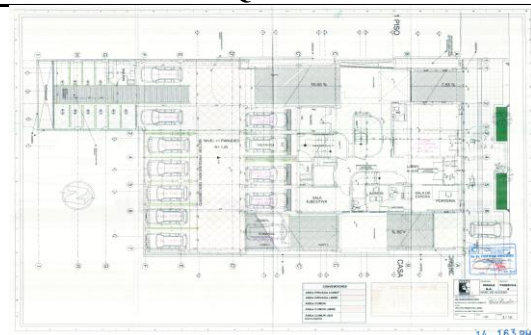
Planta arquitectónica Nivel +0,00, Nivel +1,25
